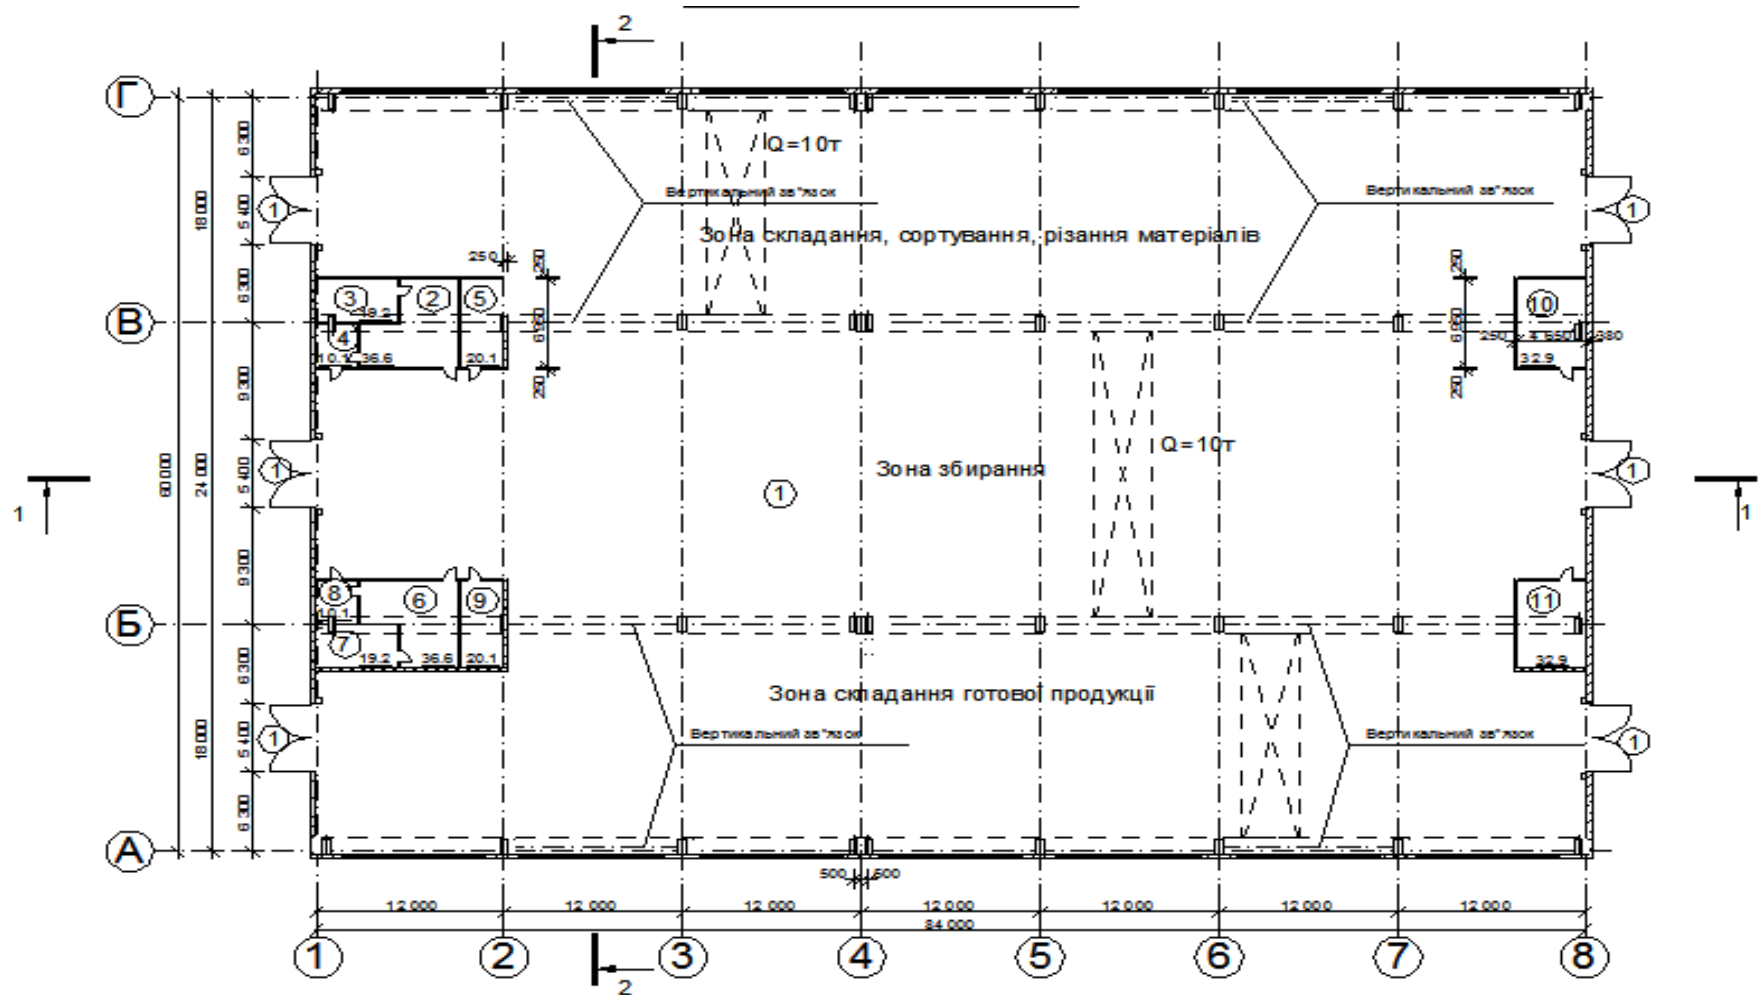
План арматурного цеху на відмітці 0,000 м
